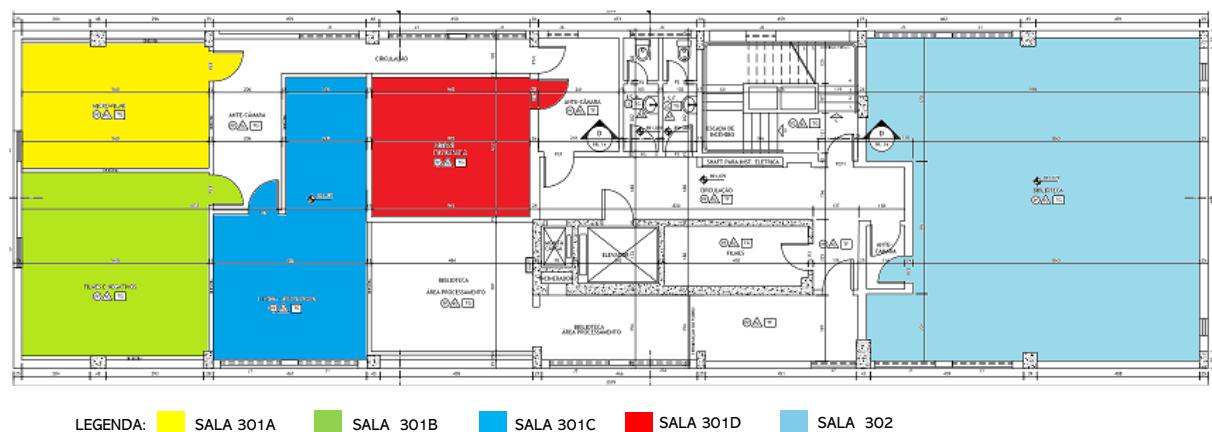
Planta baixa - 3º pavimento: salas 301a, 301b, 301c, 301d e 302.
